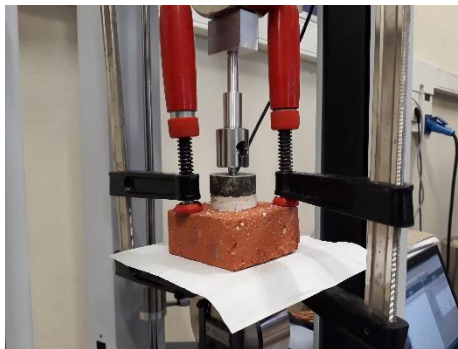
Ensaio para determinação da aderência calda/tijolo
